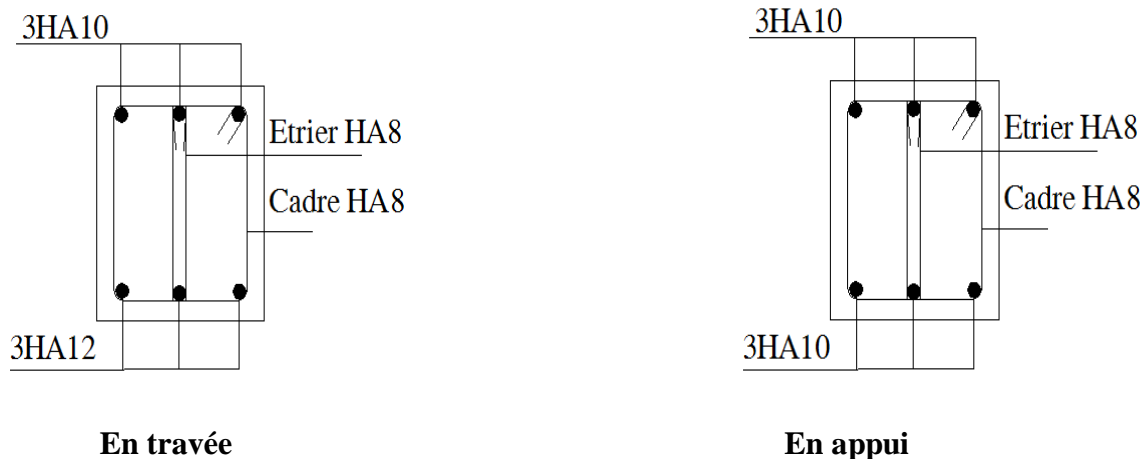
Schéma de ferrailage de la poutre de chaînage
